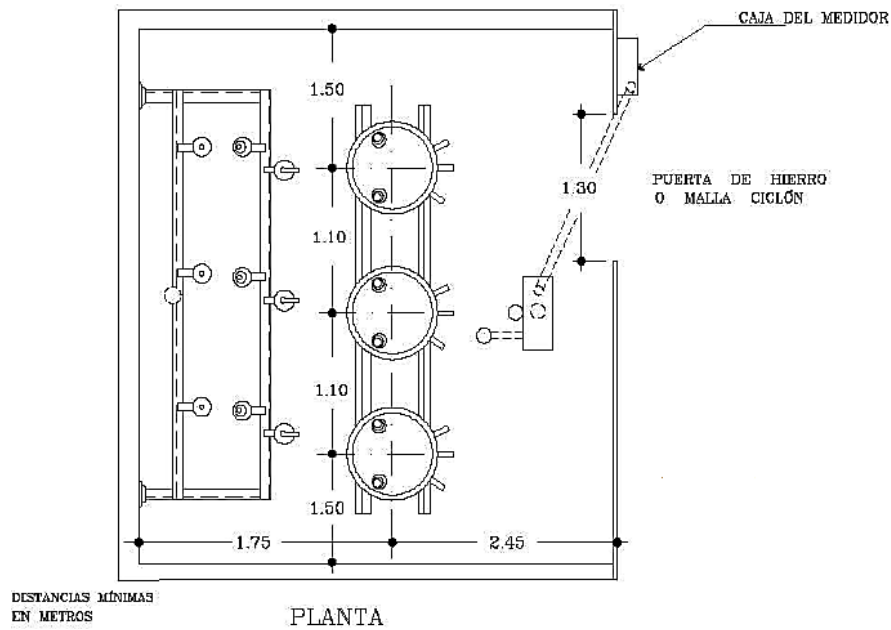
19. Vista en planta de instalación de transformadores en subestación. Tomado de: (SIGET, 2008).
